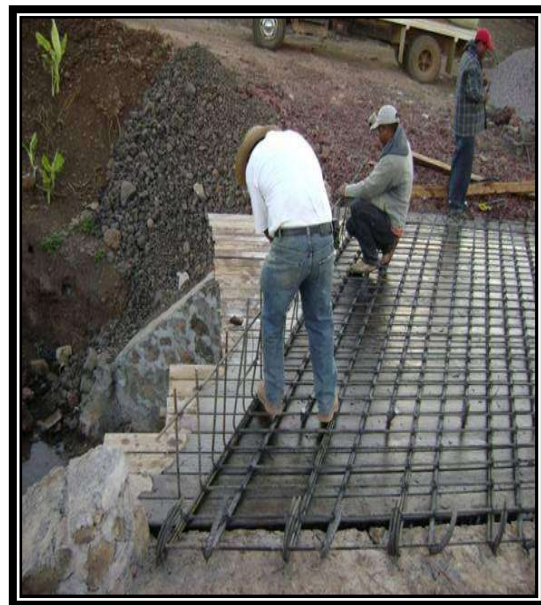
ACERO PARA ESTRUCTURAS DE CONCRETO REFORZADO.
